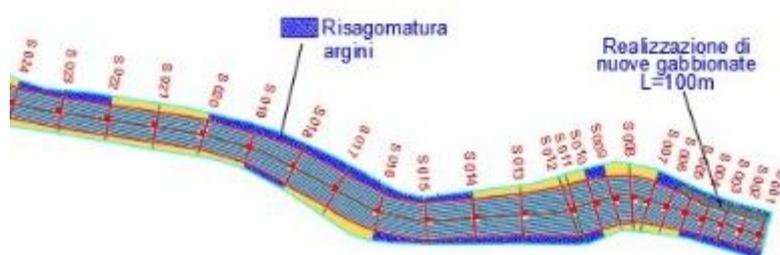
Fiume Lipuda – Planimetria con dettaglio 1 degli interventi di progetto
